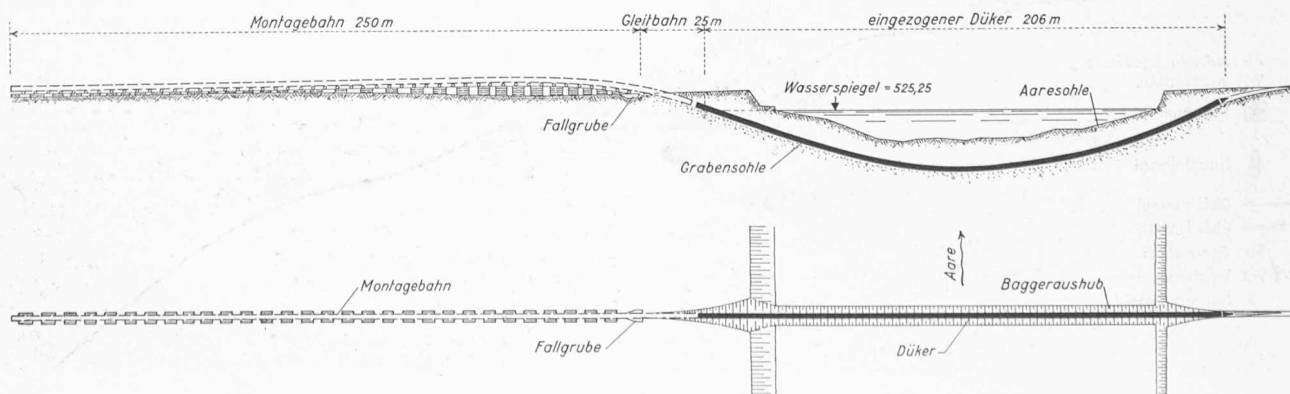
Der Düker im Längsschnitt und Lageplan, Masstab 1:3000
